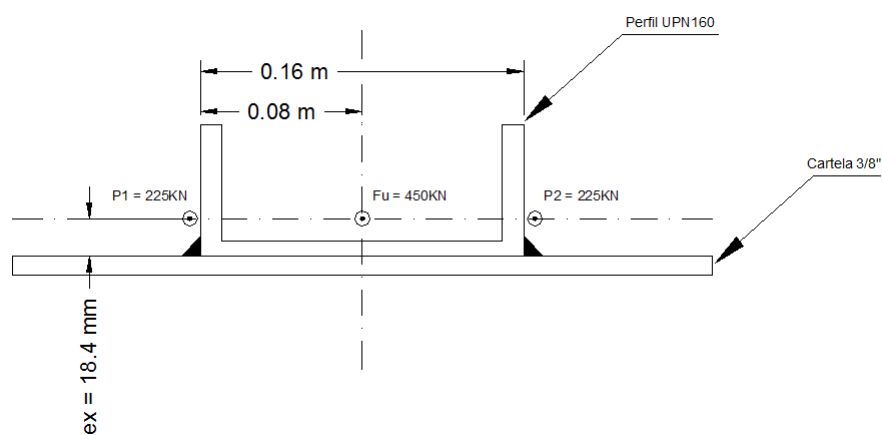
Unión soldada UPN160 con carga excéntrica
